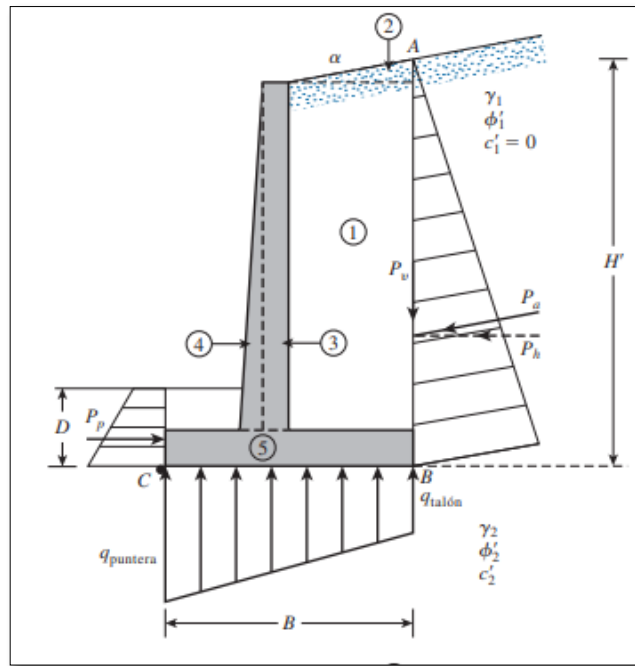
Verificación por volteo para un muro en voladizo (T. Rankine)
